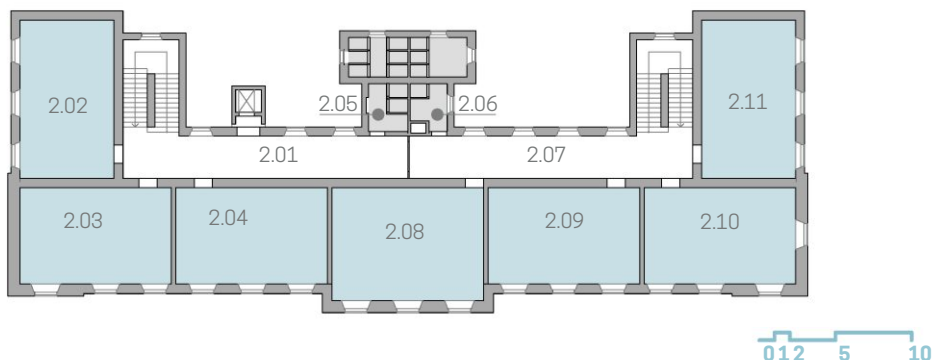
Bestandsaufnahme: Grundrisse 1. und 2. Obergeschoß.
